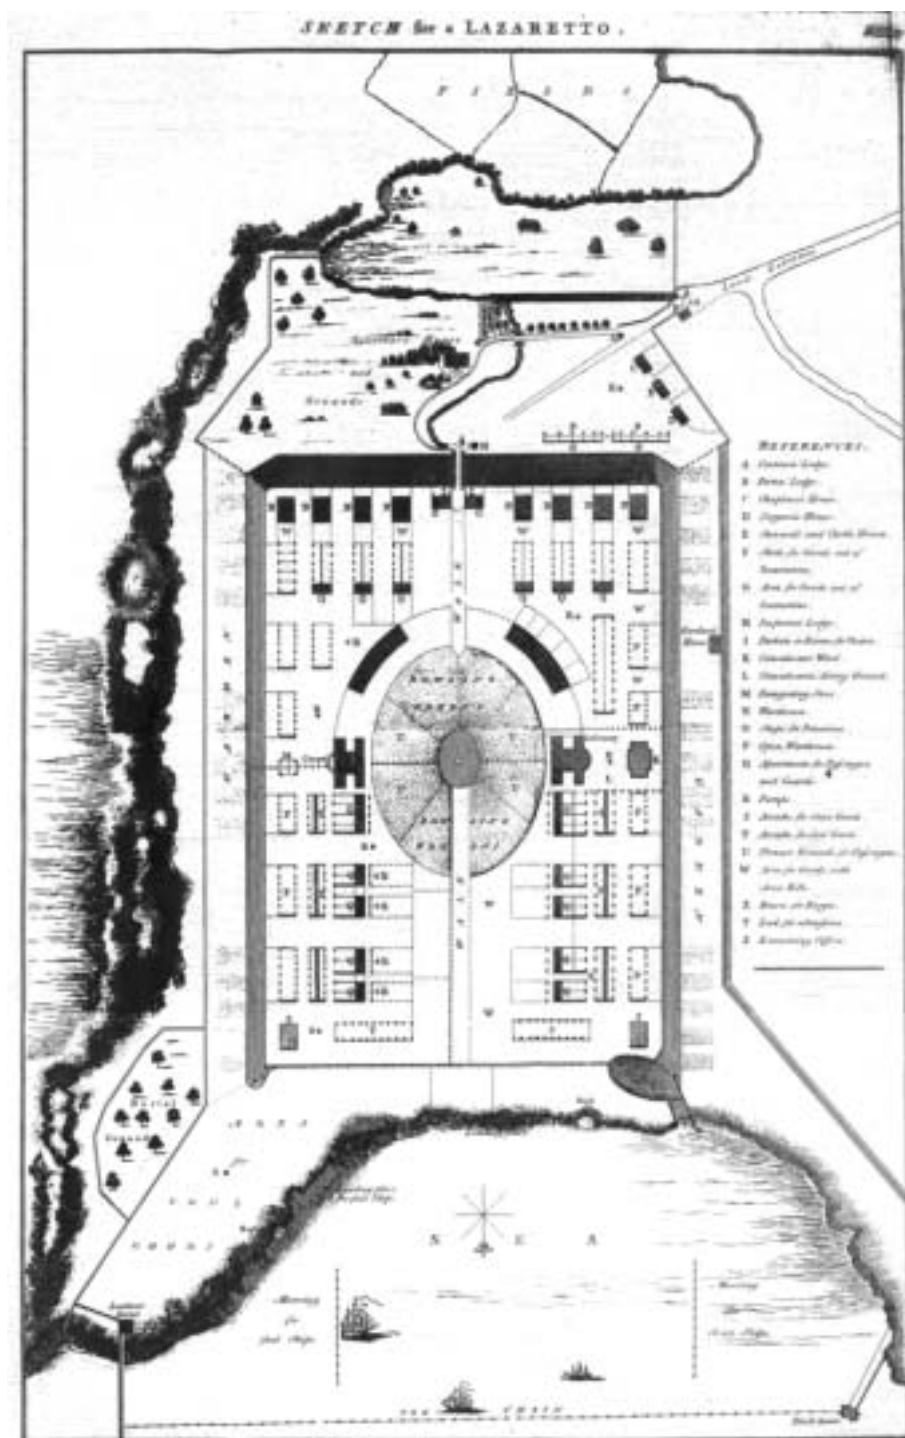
Sketch for a Lazaretto*, planta, por John Howard. En Howard, John. *An account of the principal lazaretos in Europe...* London: Johnson, Dilly and Cadell, 1791, plancha 14
